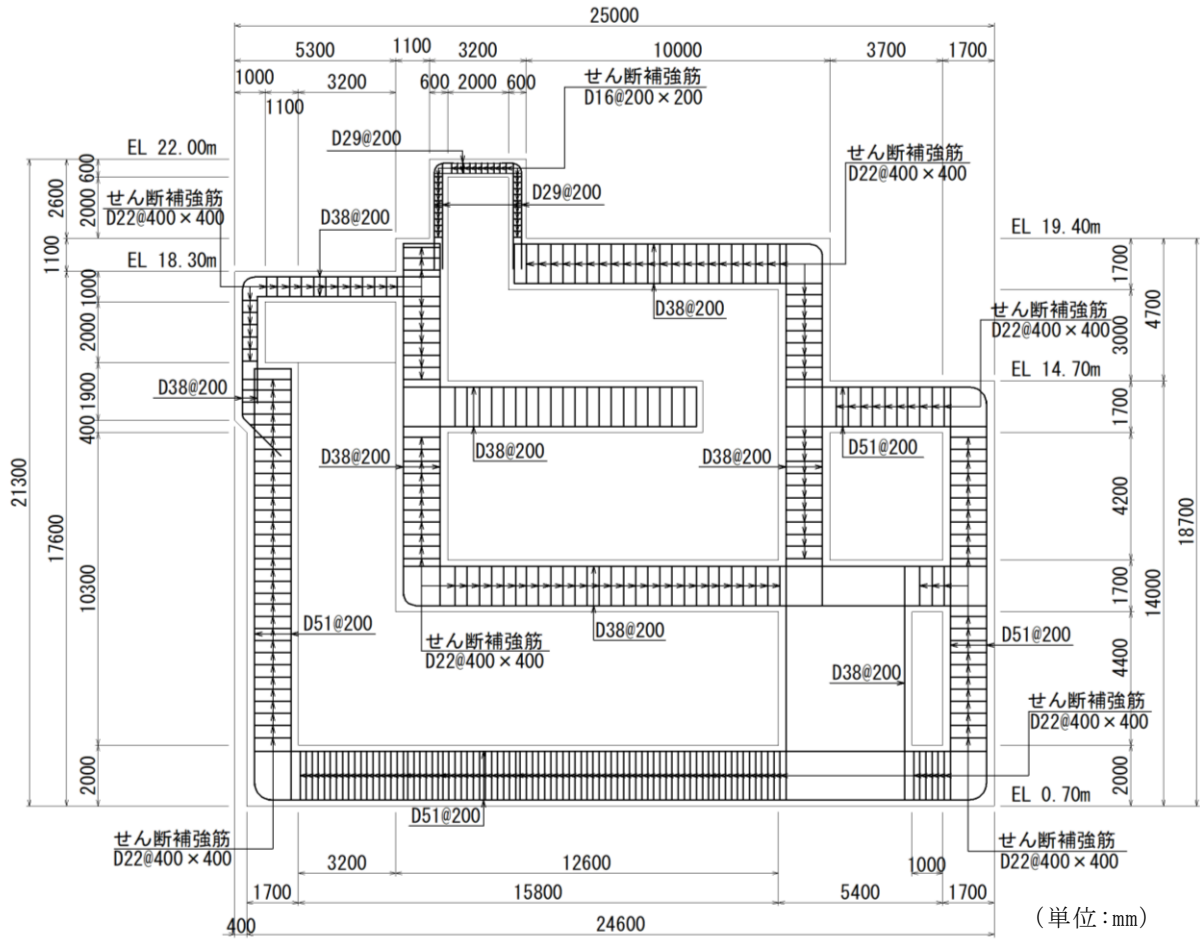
第 1 ベントフィルタ格納槽概略配筋図 (F-F 断面)
